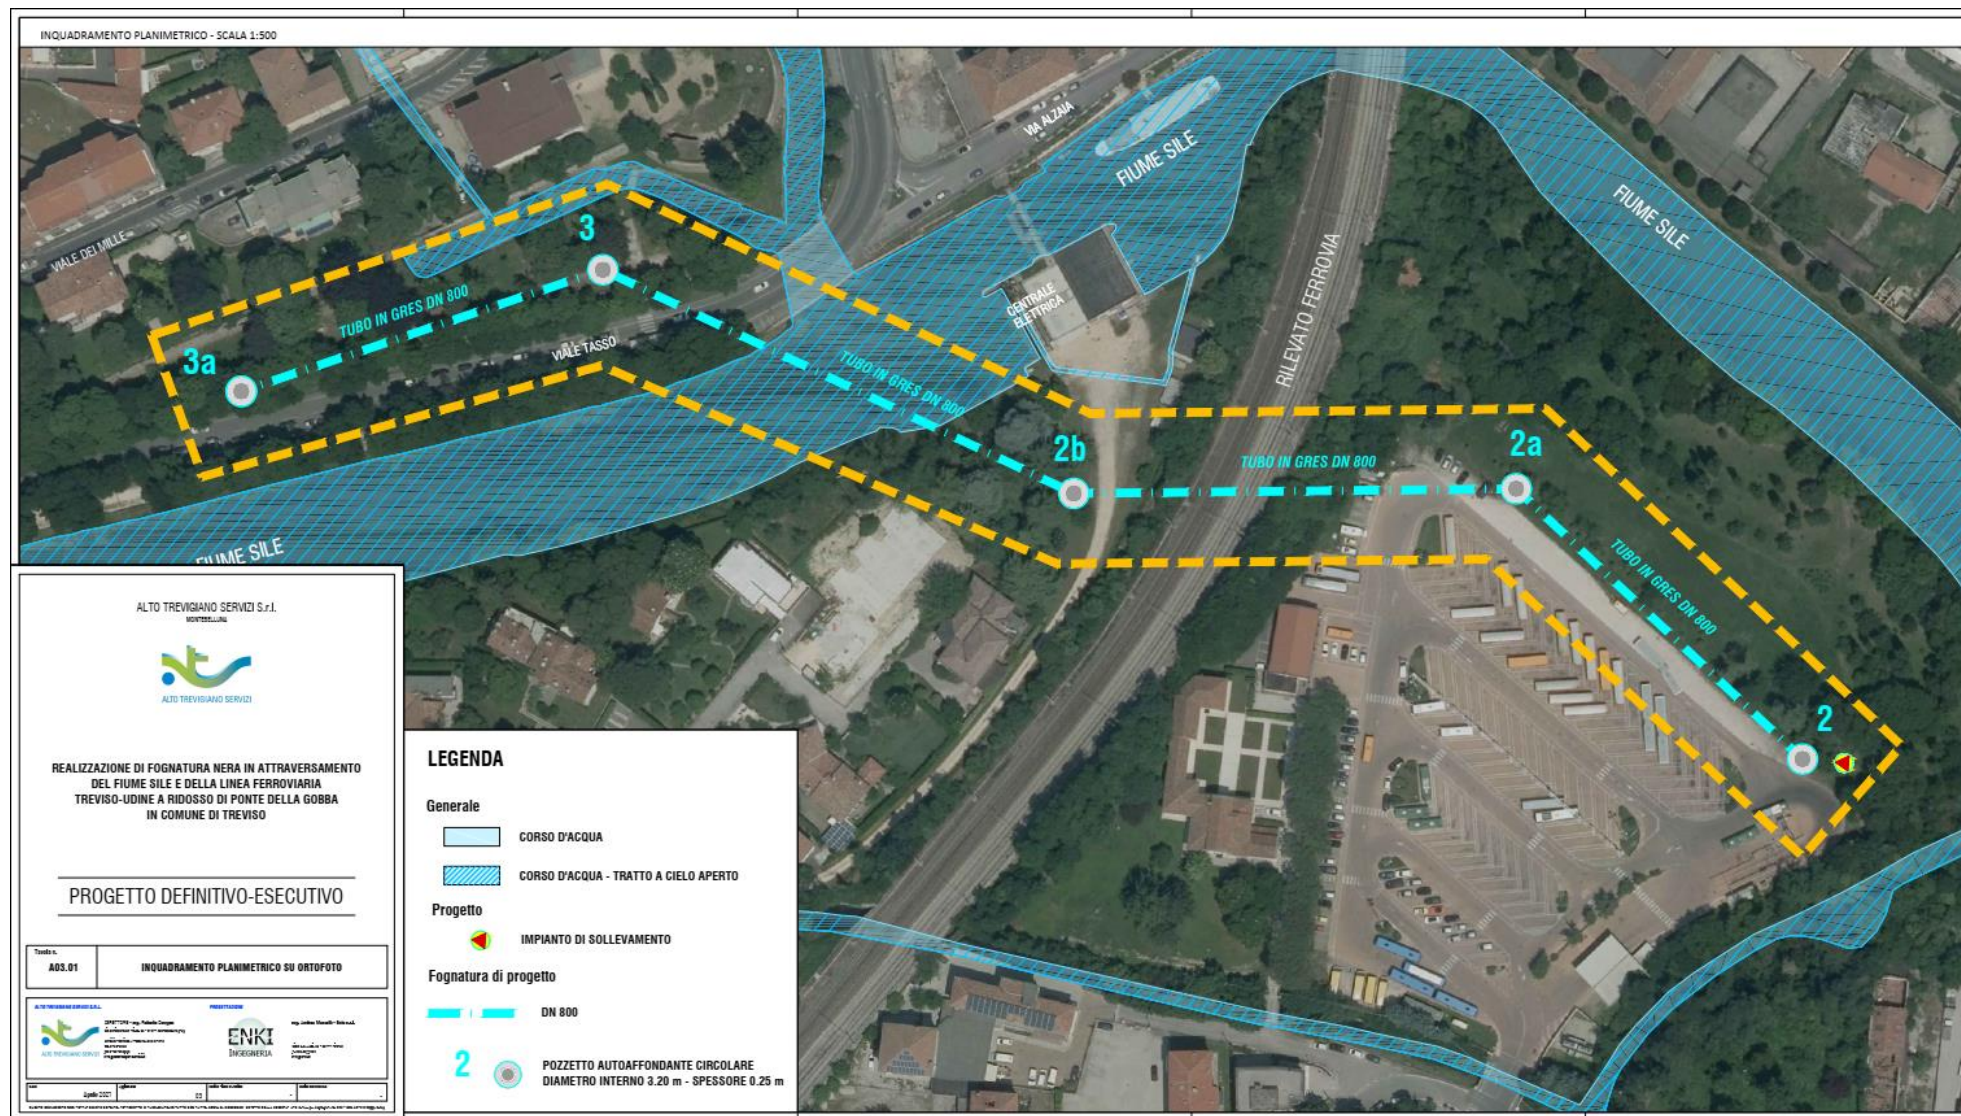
C : Estratto planimetrico giaciture condotte microtunnelling
